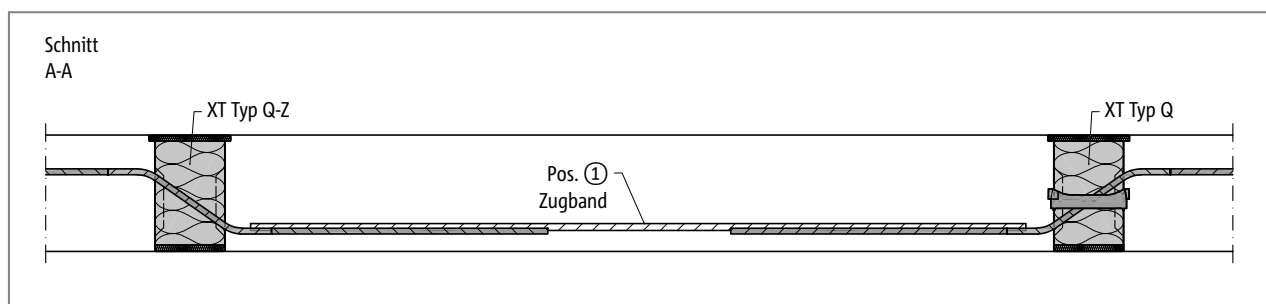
Schöck Isokorb® XT Typ Q-Z-V5 bis Q-Z-V8, Q-V5 bis Q-V8: Schnitt A-A; Einachsig gespannte Stahlbetonplatte
